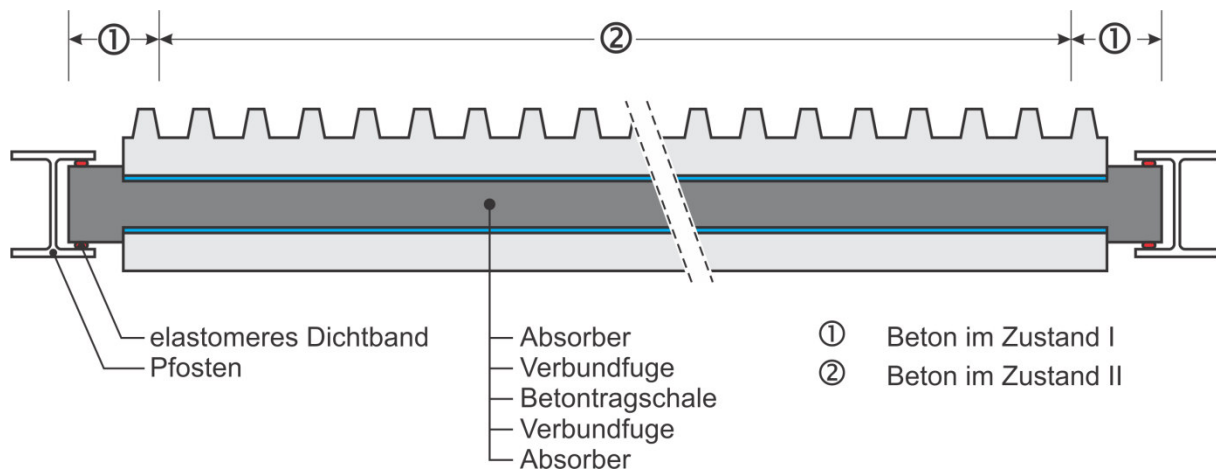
Schnitt durch ein Betonelement mit möglicher Zonierung der Tragmechanismen
